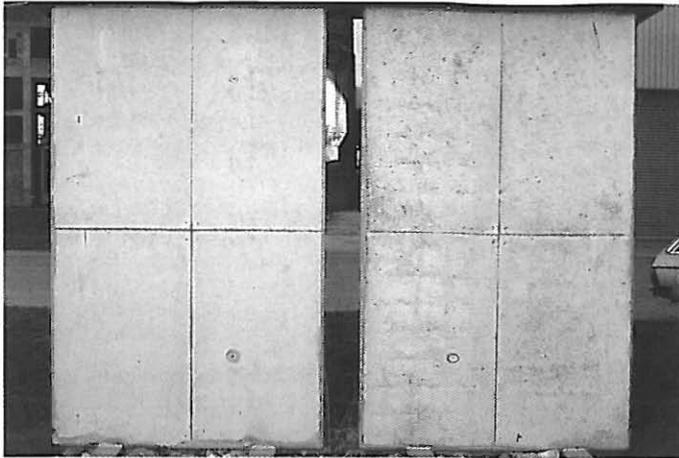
Betonbauteil mit PKZ (links) und PZ (rechts) in glatter Schalung, Betonzusammensetzung siehe Bilder 4 und 5
